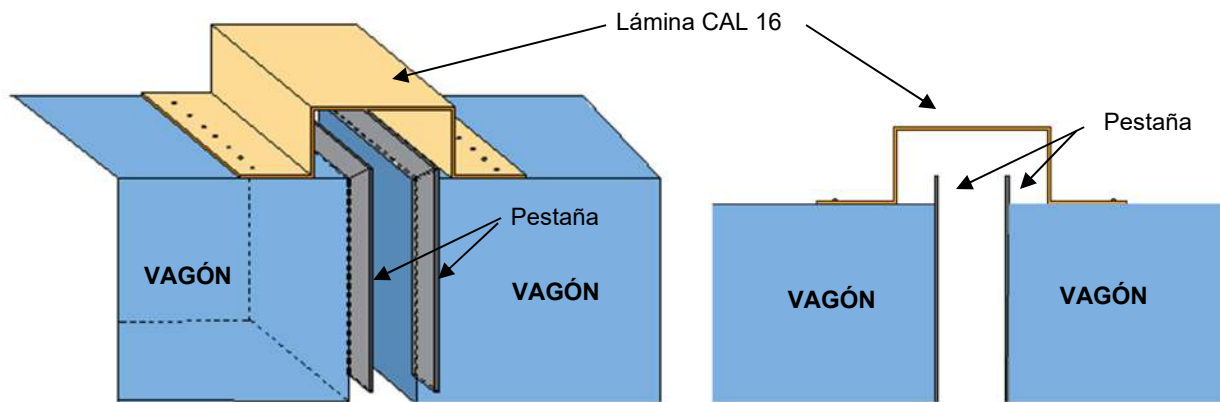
Esquema ilustrativo disposición de lámina en junta y pestañas sobre junta.
